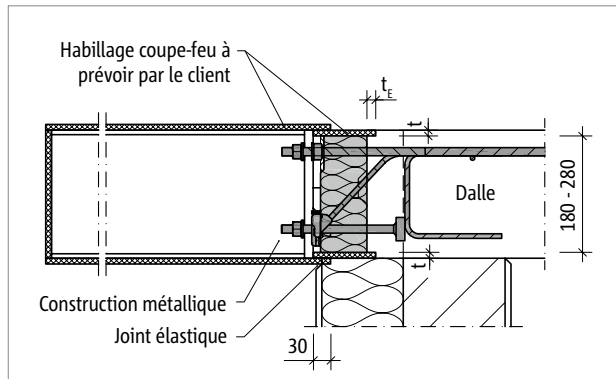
Schöck Isokorb® T type SK : bardage de protection incendie sur site pour Isokorb® et structure en acier ; coupe
